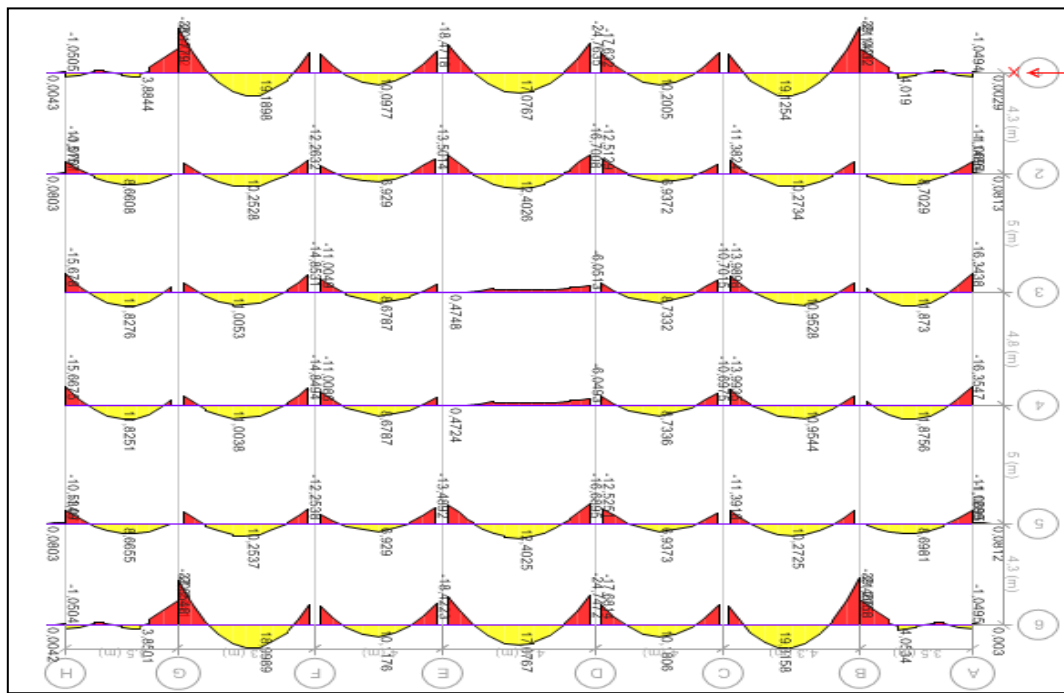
Moment fléchissant des poutres secondaires(ELU)
